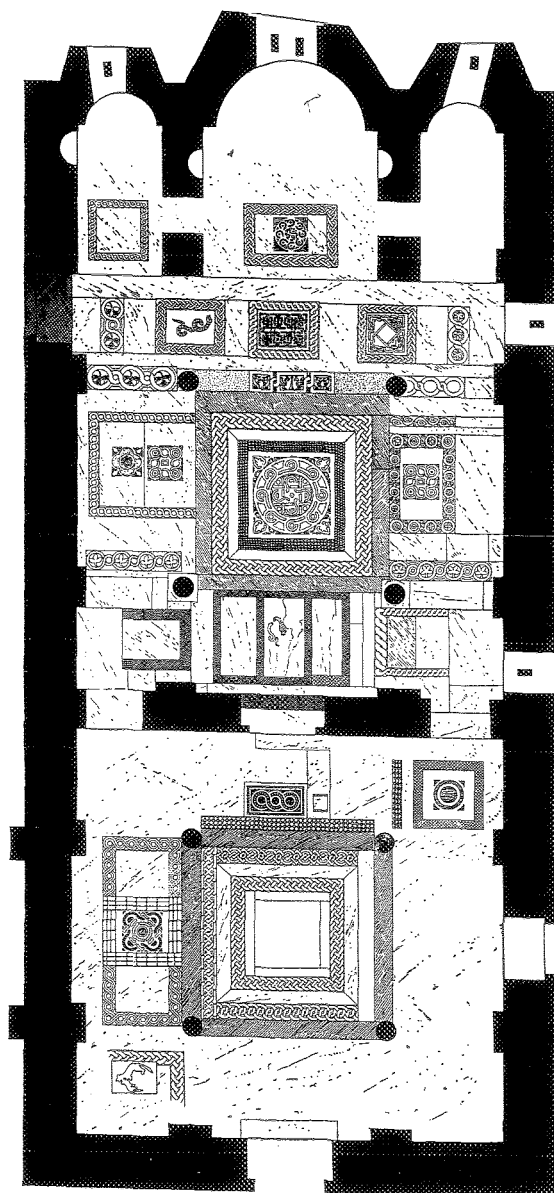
Sagmata, pianta del pavimento (da A.K. Orlandos, 1951).
